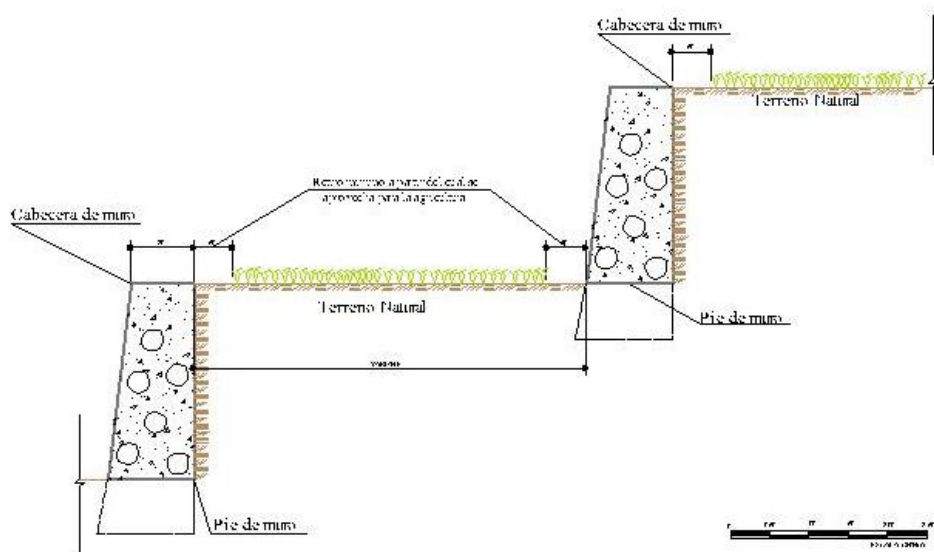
Vista de sección transversal andenería inca del P.A.O tipo 1.
